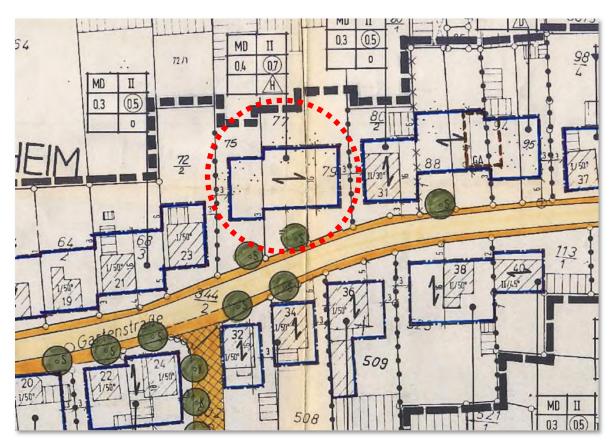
Auszug rechtskräftiger Bebauungsplan "Gartenstraße", freier Maßstab
